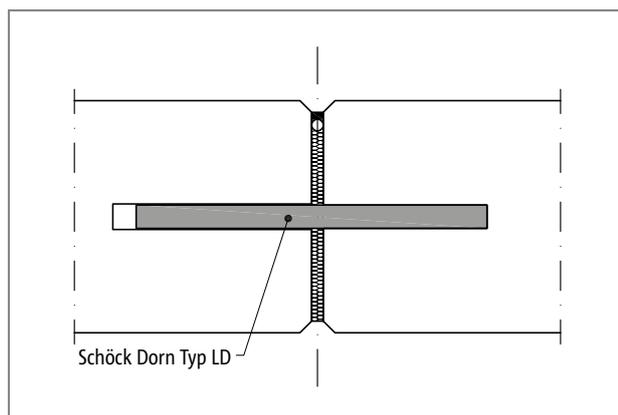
Schöck Dorn: Dehnfugenausbildung Ortbeton
